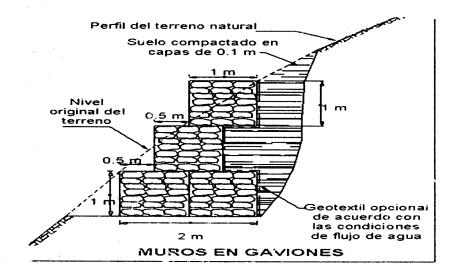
Plano Perfil Obras de geotecnia propuestas en el arroyo Palenquillo.
